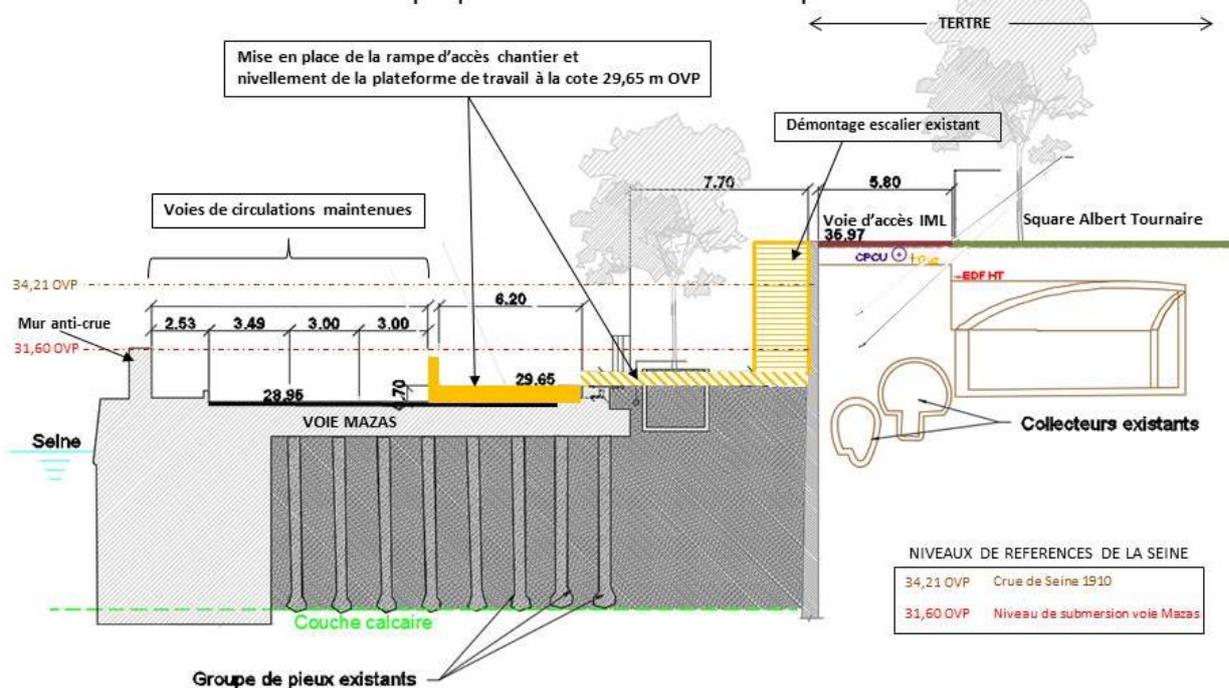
Coupe sur la réalisation des travaux préparatoires (réalisation de la rampe et de la plateforme)
